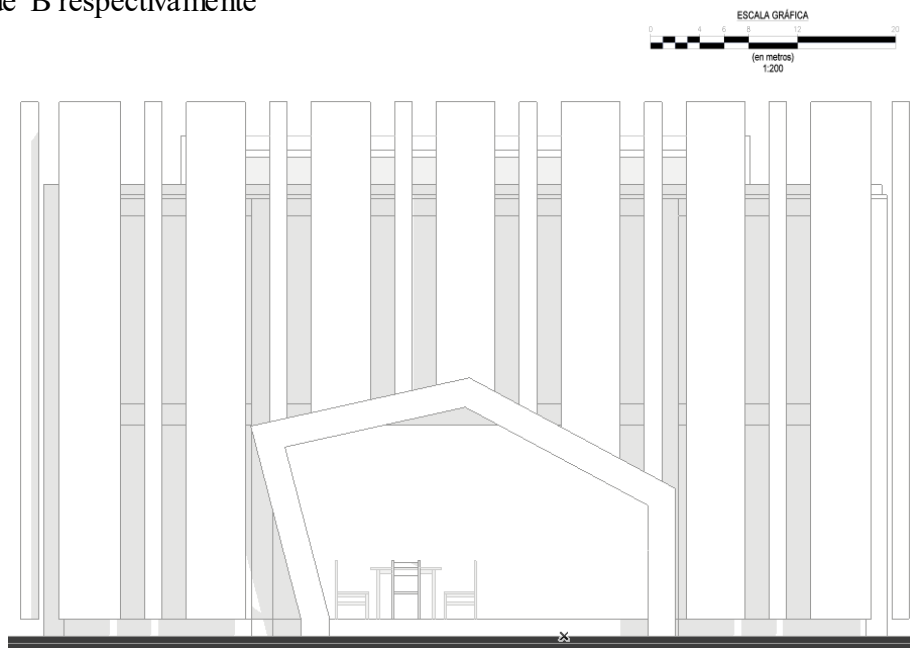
Fachada frontal - bloque C / Fuente: Propia
